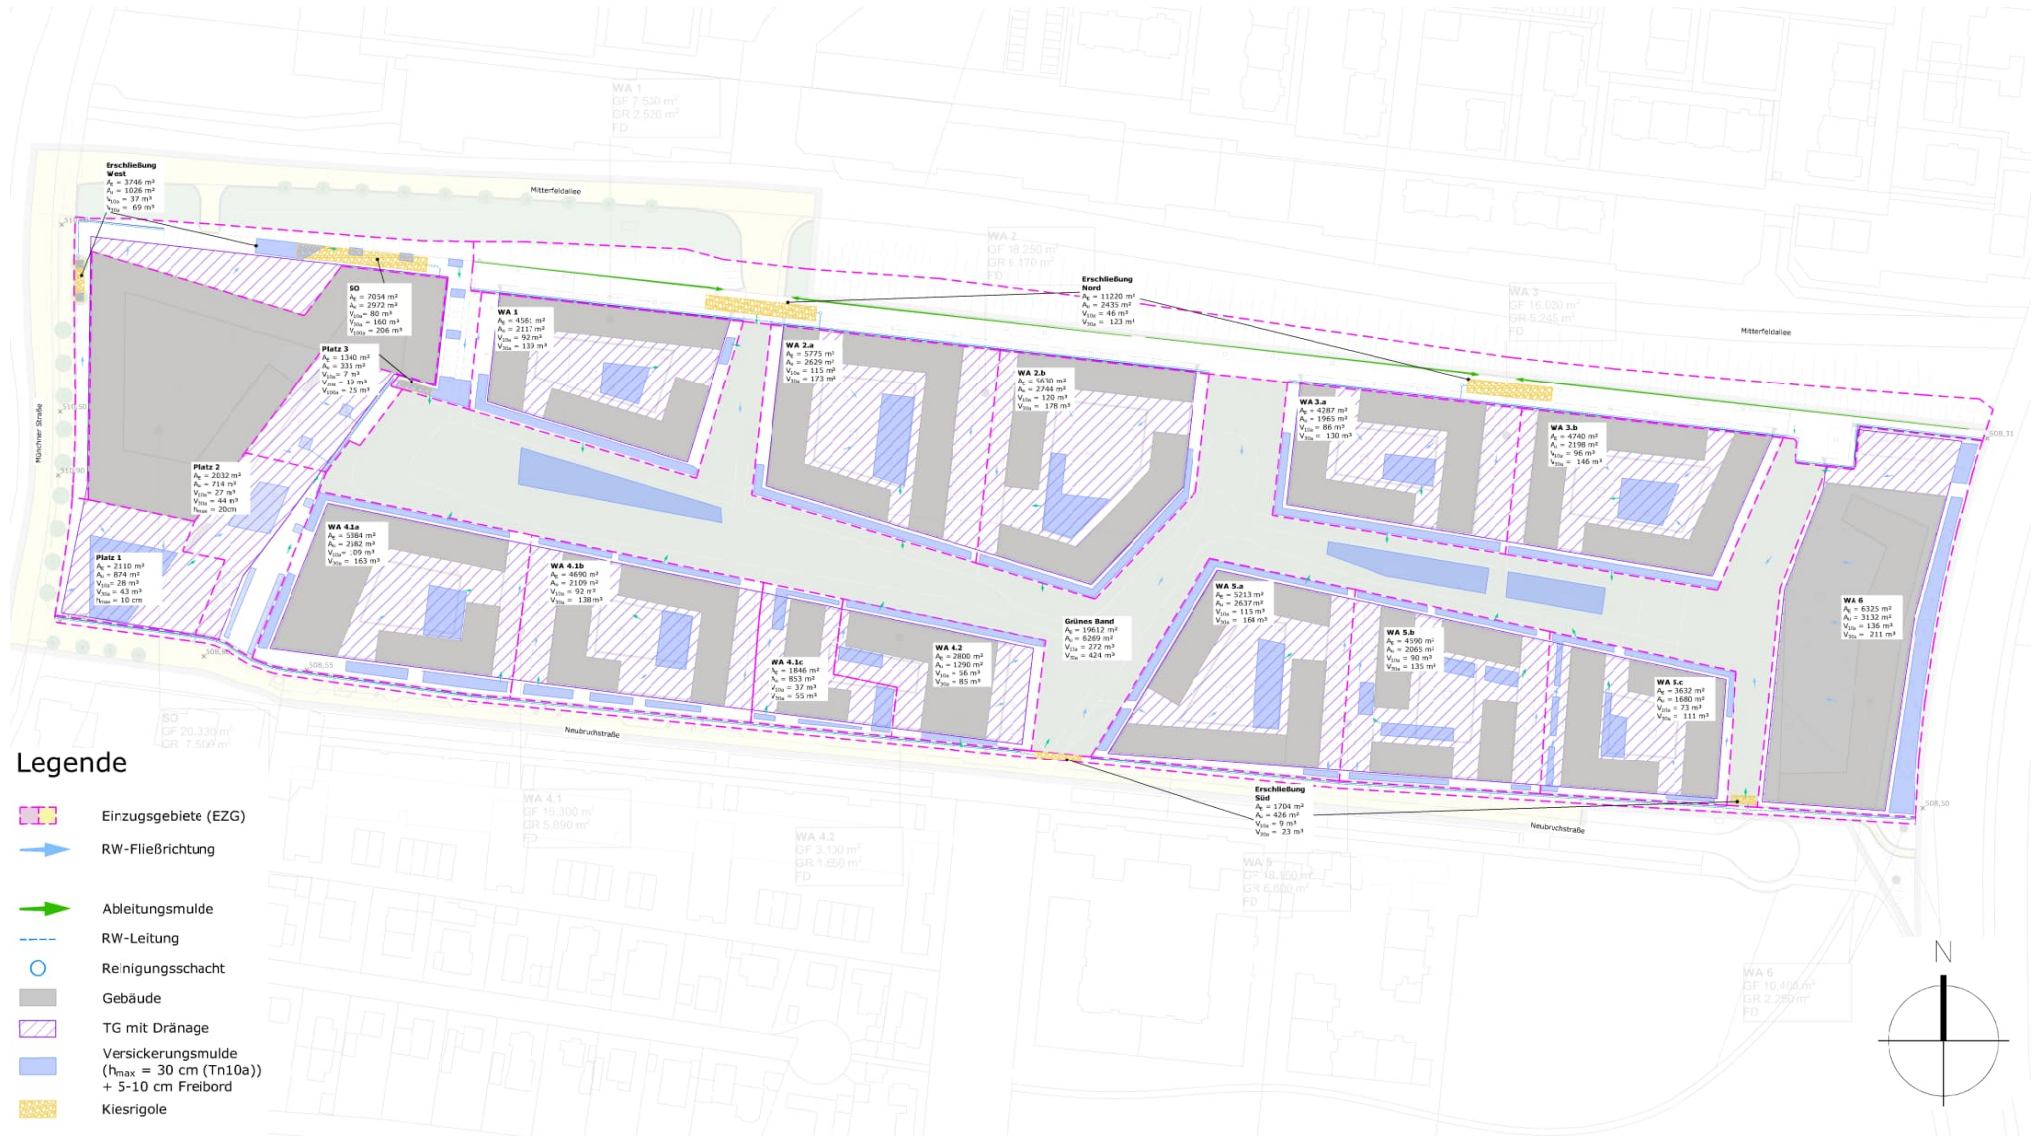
Lageplan RW-Konzept Variante 1 (HL)
